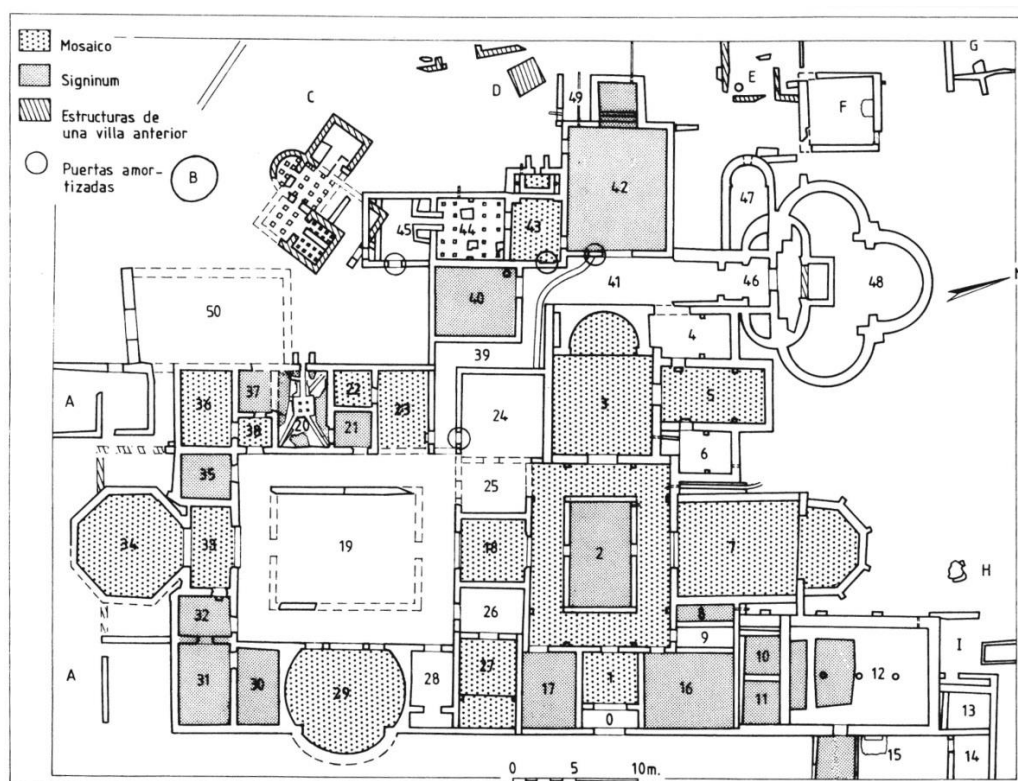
Planimetría de la *villa* de Almenara de Adaja (Valladolid).
